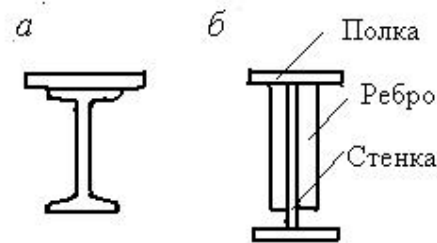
Стальные подкрановые балки: а – сплошного сечения с усиленным прокатным двутавром; б – то же составного сечения
